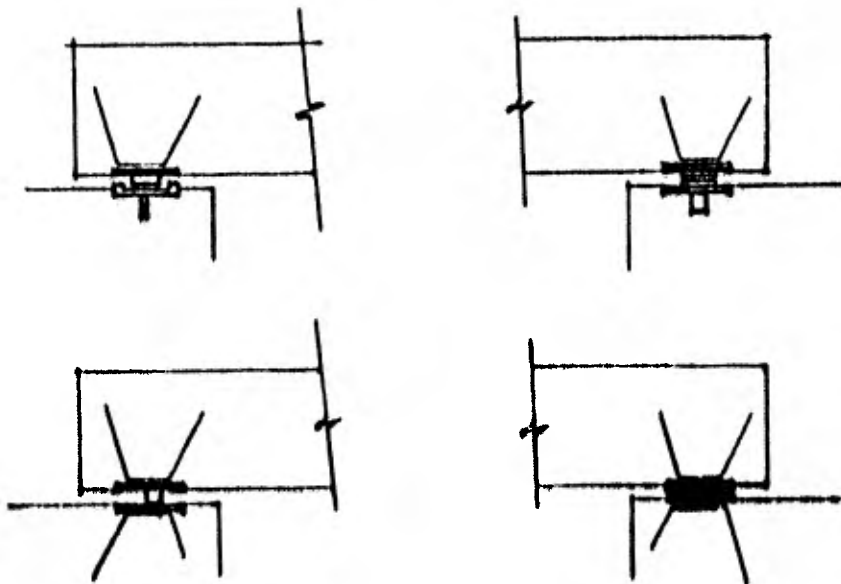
APOYOS DE PLACAS PLANAS DE ACERO
